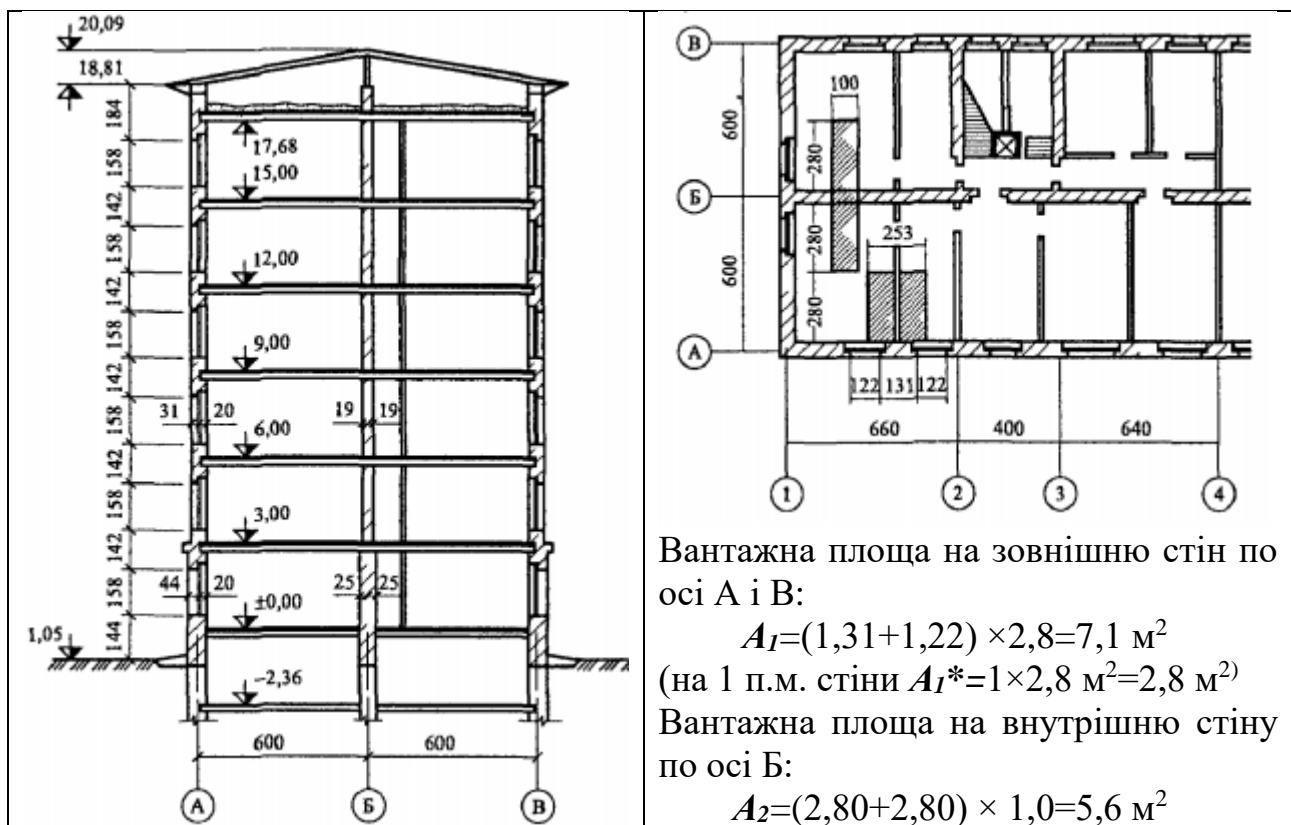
Схема 6-ти поверхового безкаркасного житлового будинку
